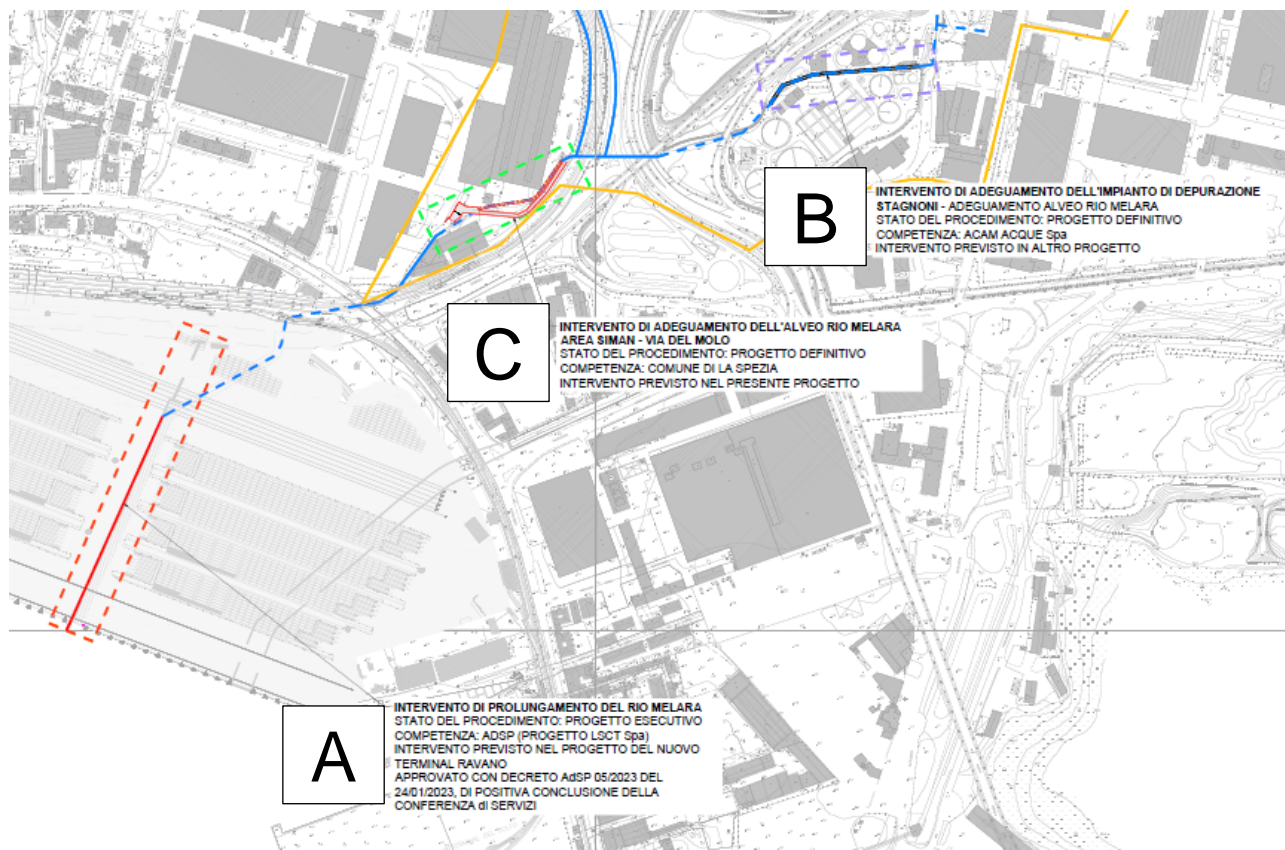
Individuazione degli interventi previsti sul Fosso Melara.
